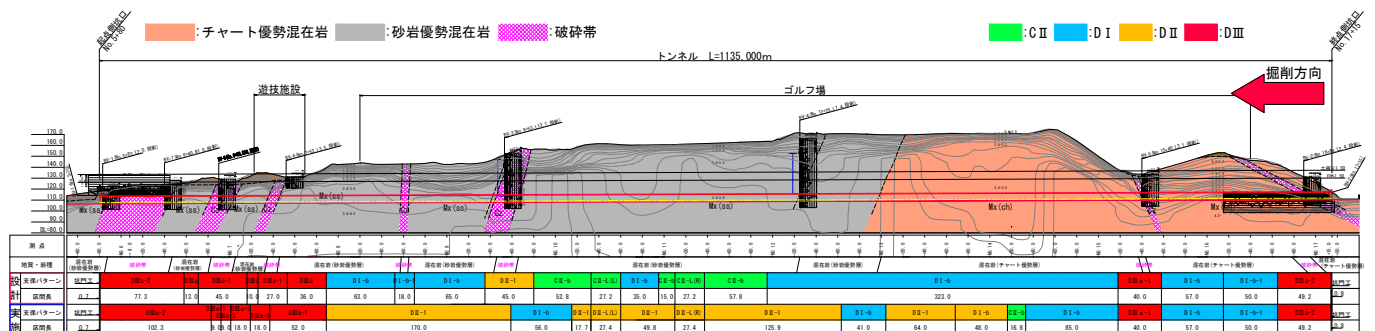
トンネル地質縦断面図および支保パターンの設計と施工比較図
